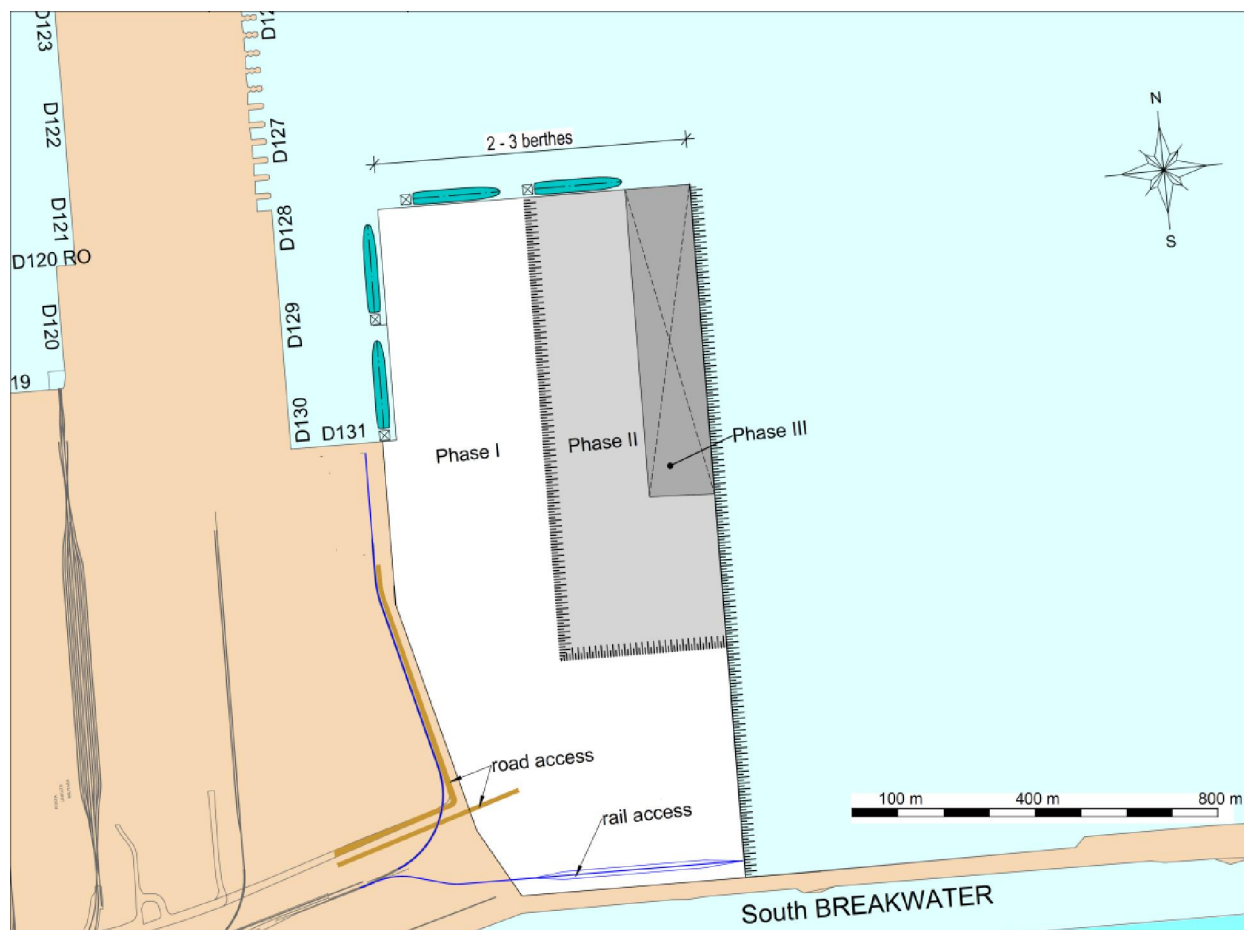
Planul de situație alternativ pentru construcția terminalului RoRo și pentru autoturisme în Portul Constanța Sud-Agigea (Mol III S).
